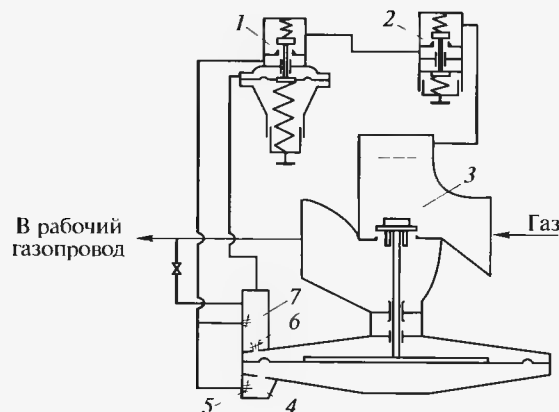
Схема регулятора давления блочного Ф. Ф. Казанцева РДБК-1:
